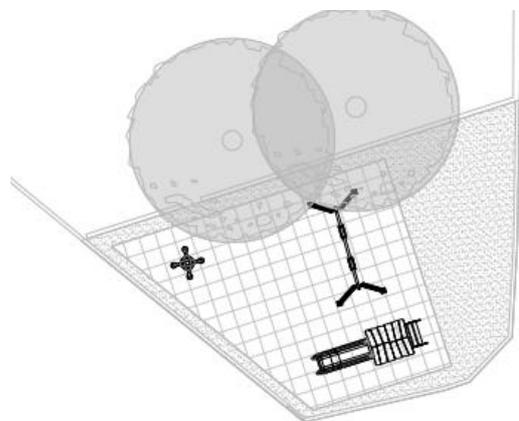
Planta da situação existente | Fonte: autora, 2023 | sem escala
